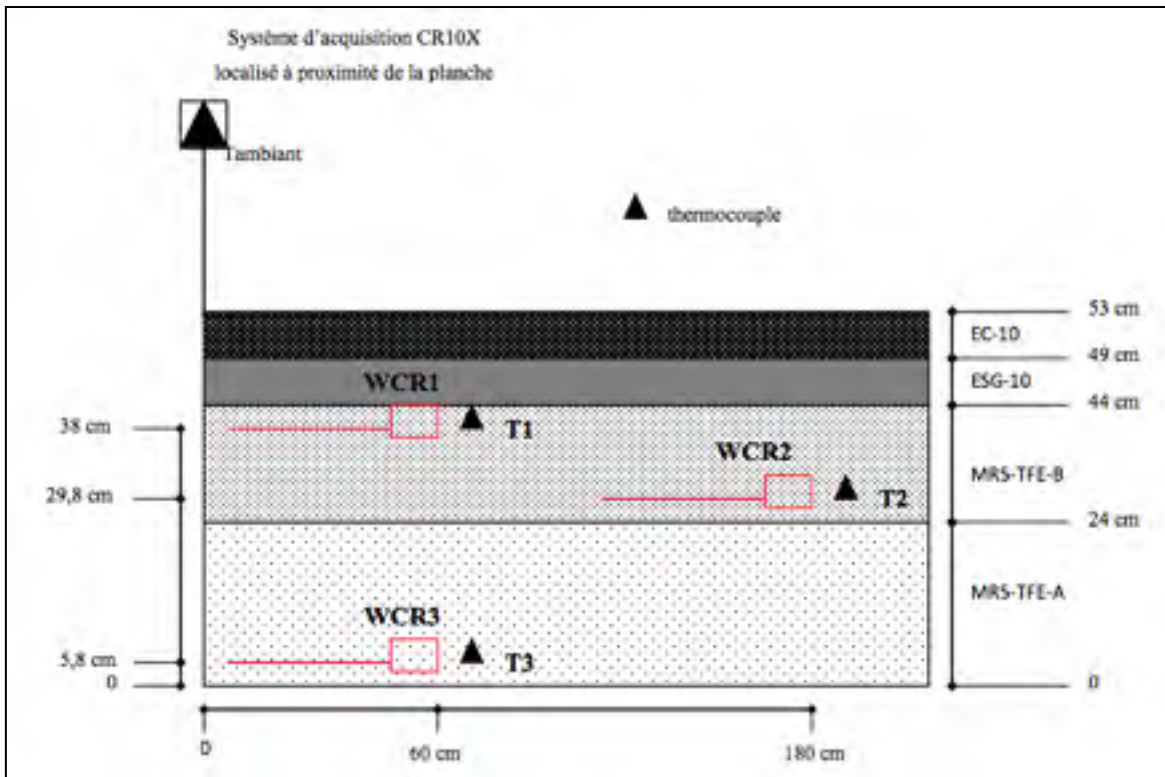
Schéma du positionnement des sondes WCR et des thermocouples dans la chaussée bitumineuse instrumentée dans le cadre de la planche d'essai avenue des Érables (coupe transversale)
